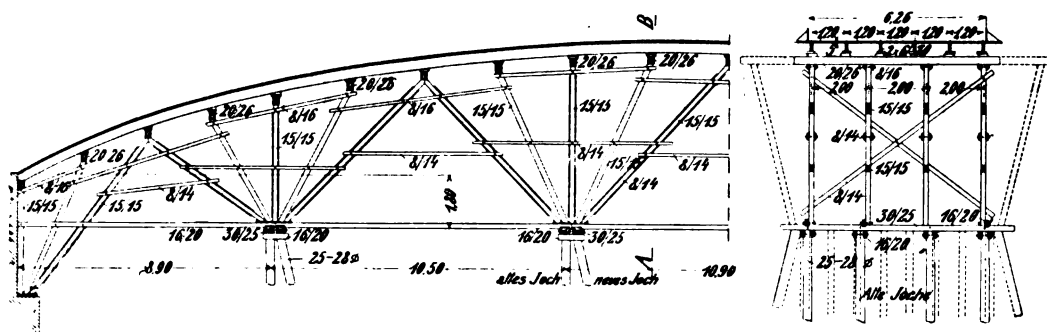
Lehrgerüst der Ybbsbrücke bei Allersdorf.
